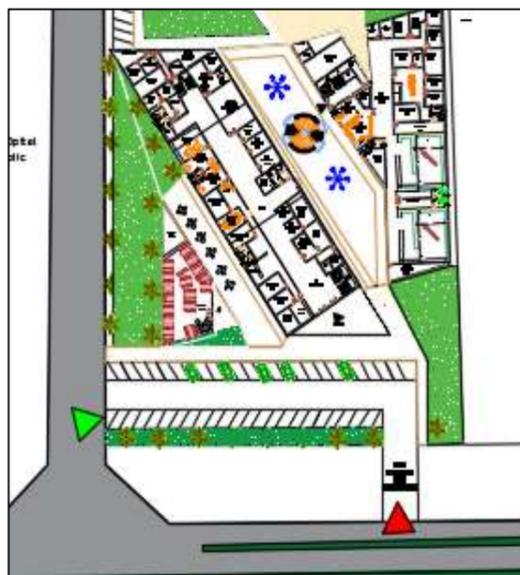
l'accessibilité de centre vue de plan /source: auteur
